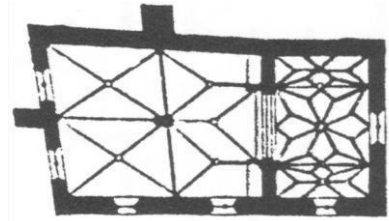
Vianden, Trinitarierkirche, Grundriss
